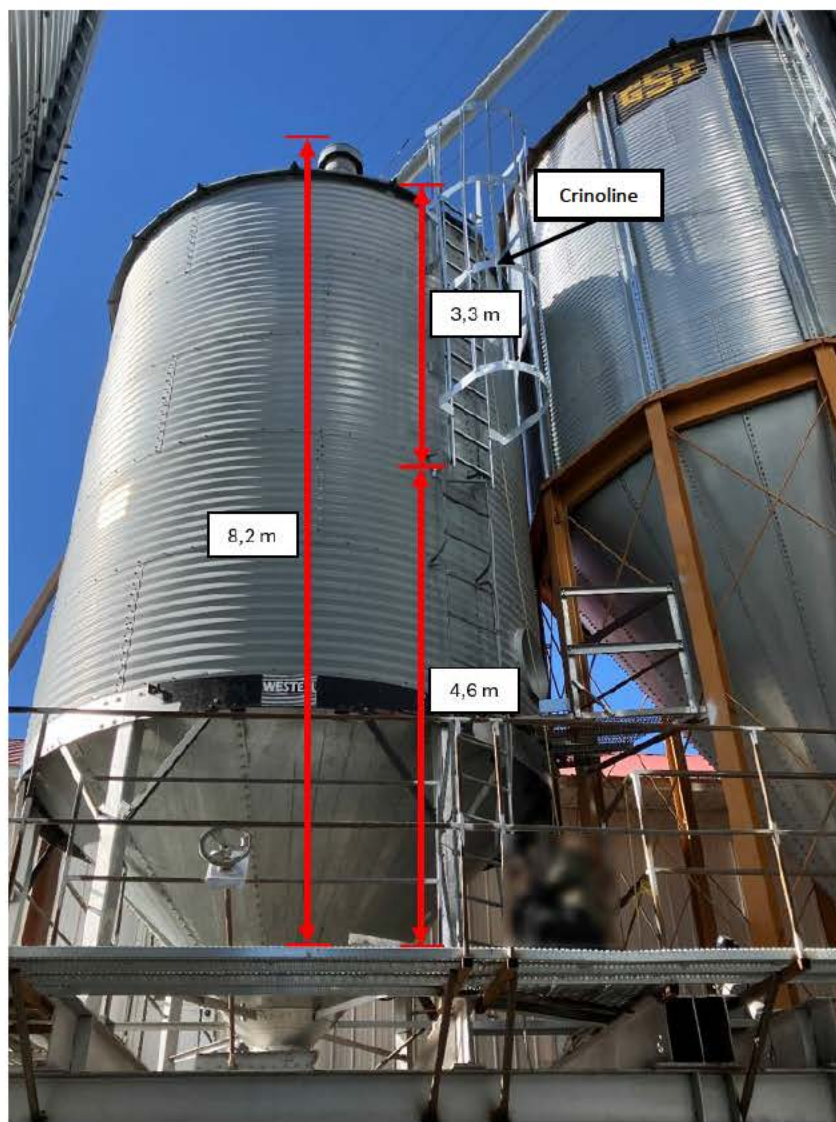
Dimensions du silo C4 à partir de la passerelle
